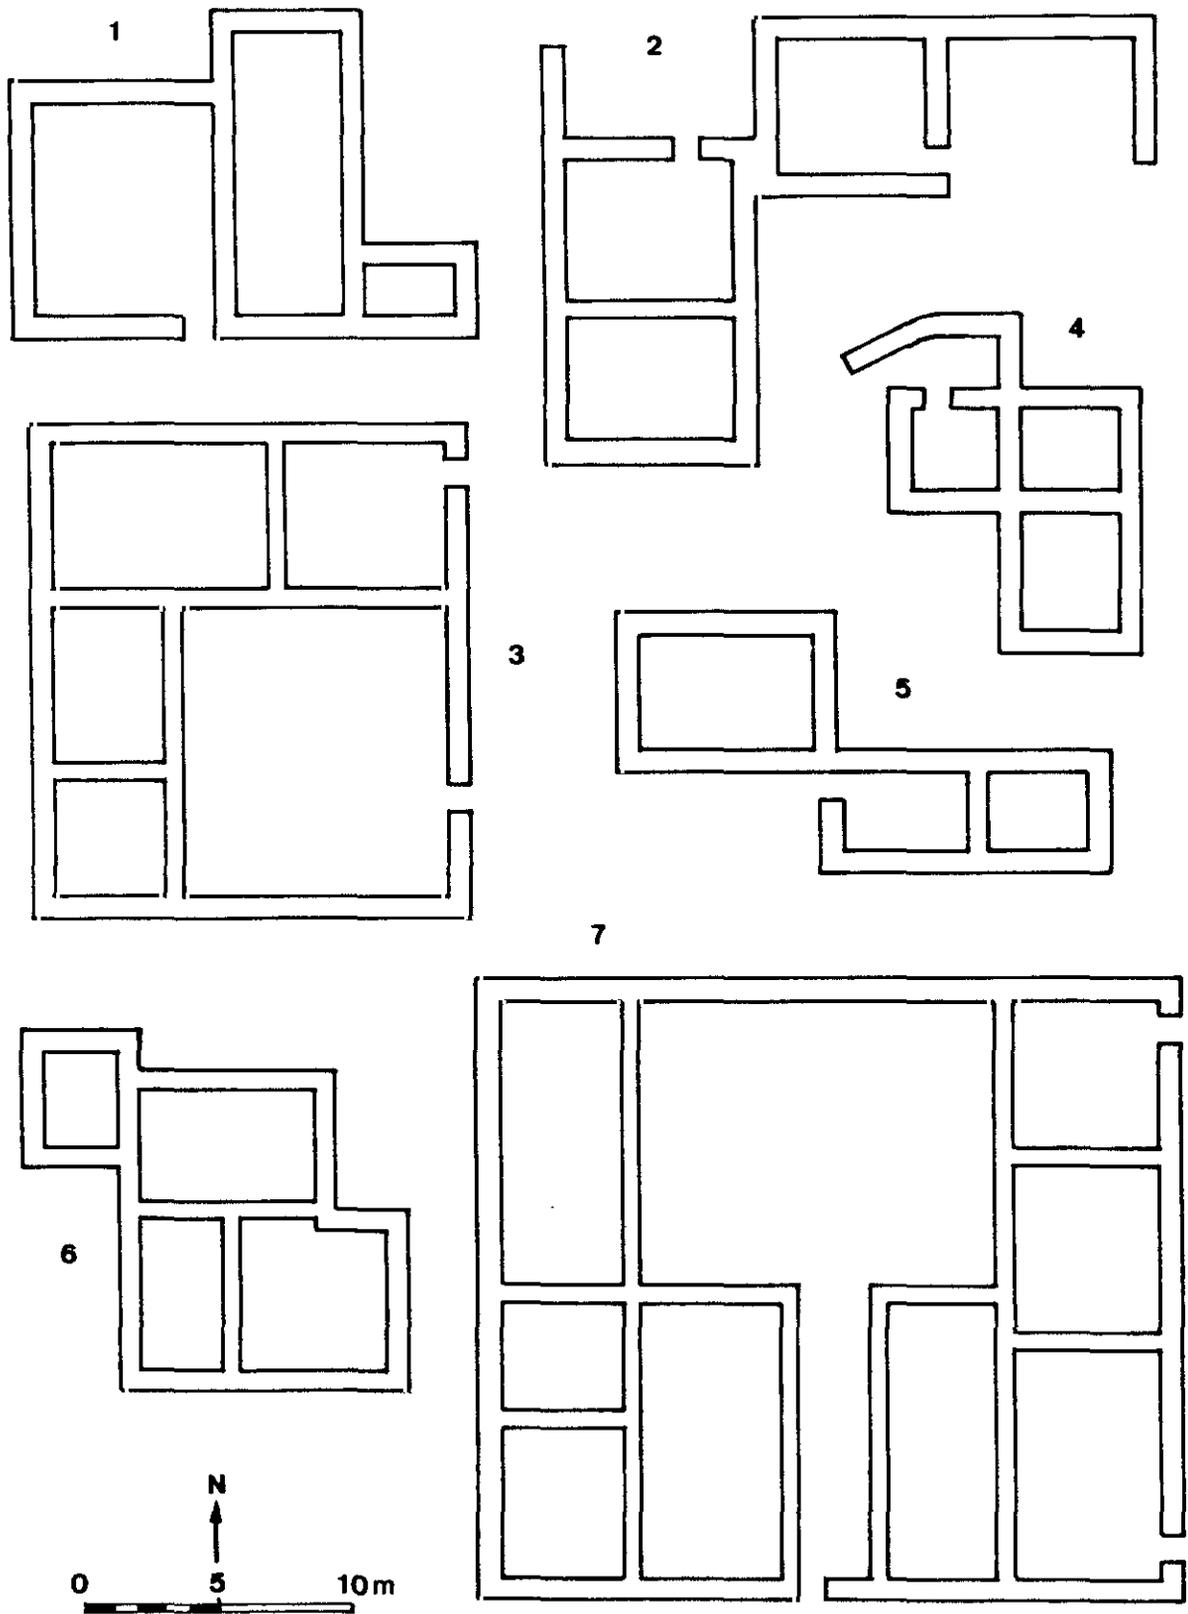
Croquis de plantas de estructura compleja del castro de Ulaca, Solosancho (Avila).
